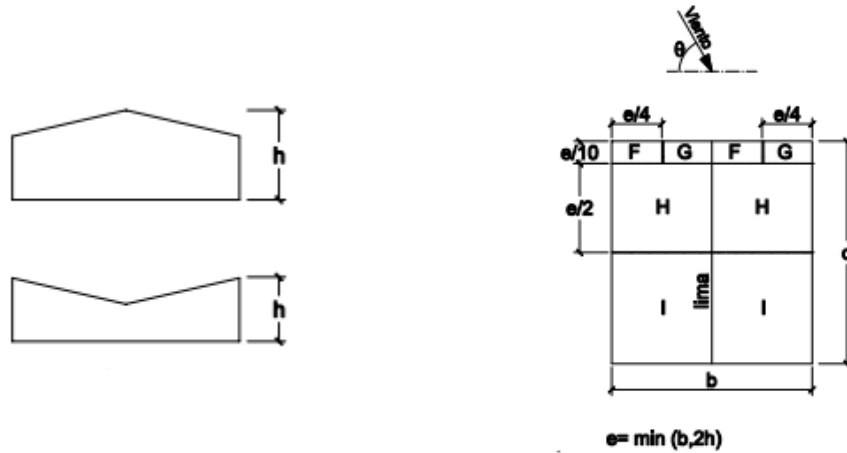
Determinación de regiones en cubierta con viento a 90°. Alzados y planta de la nave (6).
